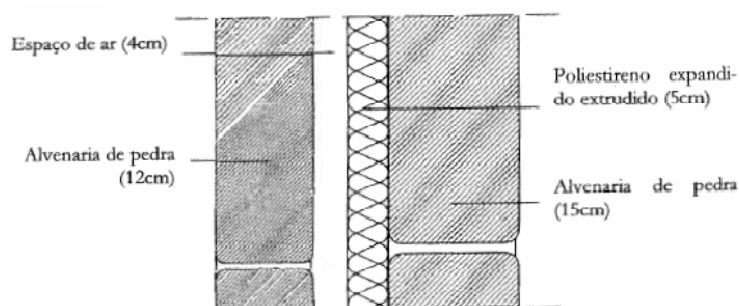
Parede dupla com panos em alvenaria de pedra aparelhada [14]
